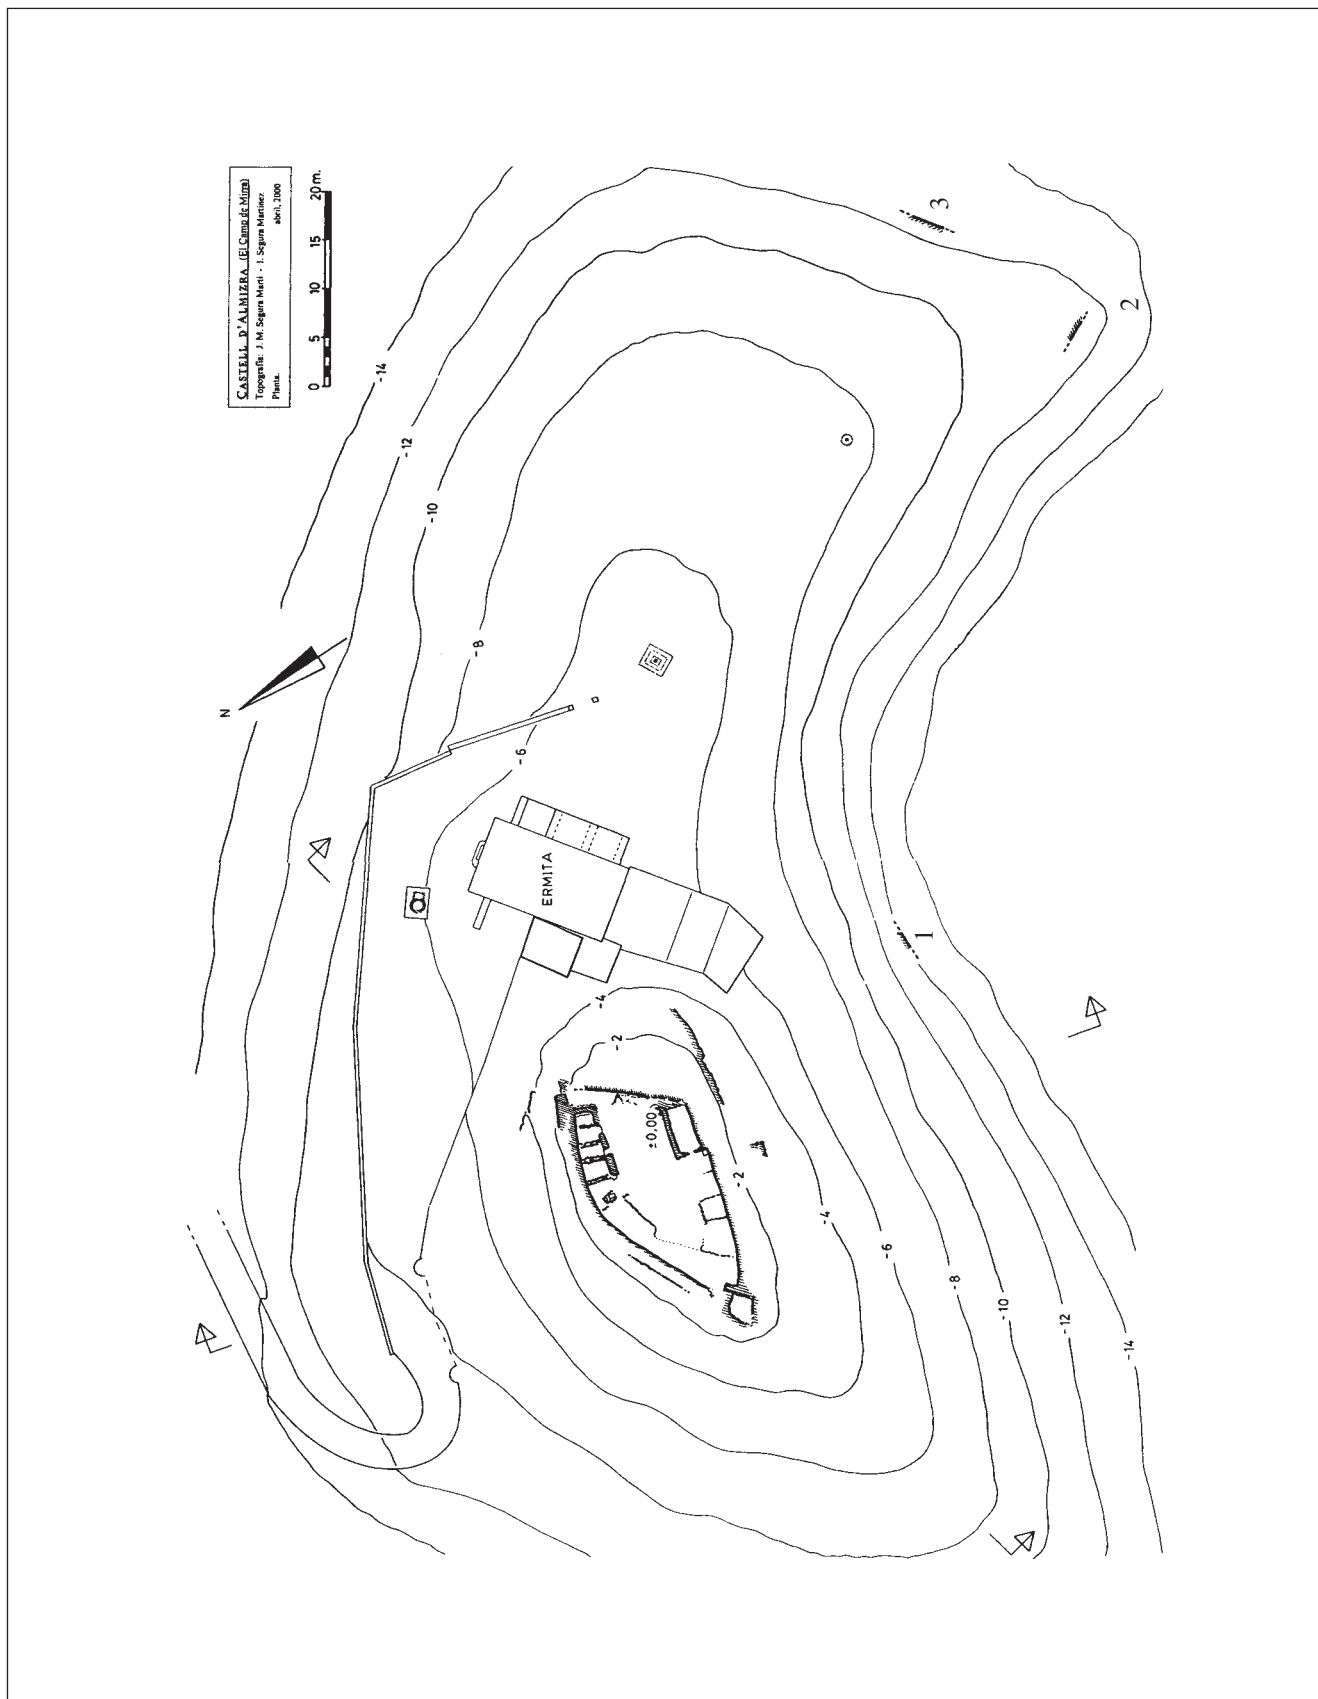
Castell d'Almizra, plano de planta general del conjunto de los restos. El muro situado al NW, entre las cotas -8 y -10 es una pared de contención moderna para la explanada de la ermita.
